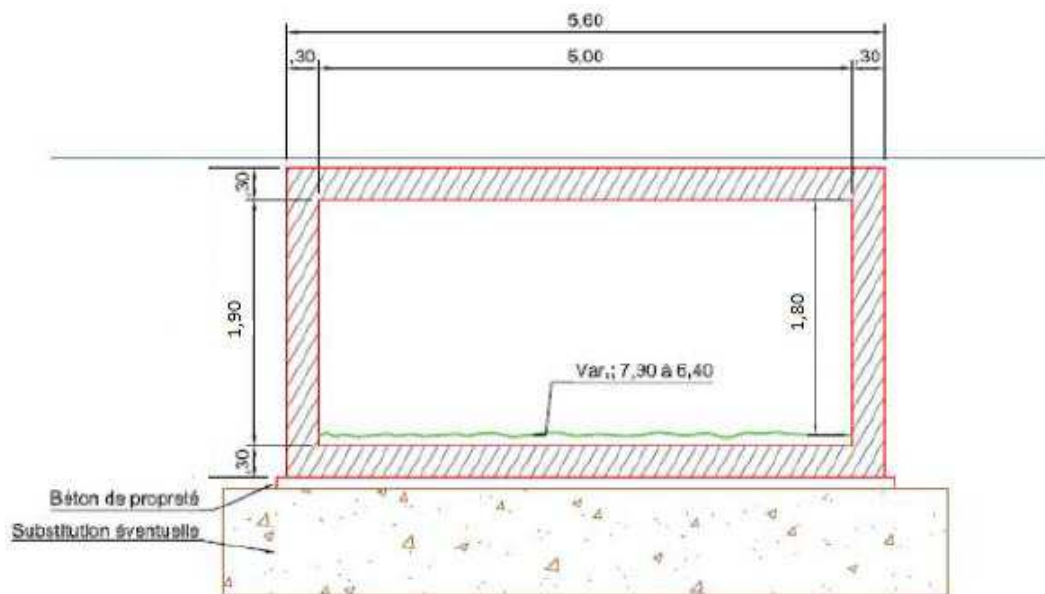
Schéma de l'ouvrage hydraulique sur la ravine Deschenez (Source : Egis)
